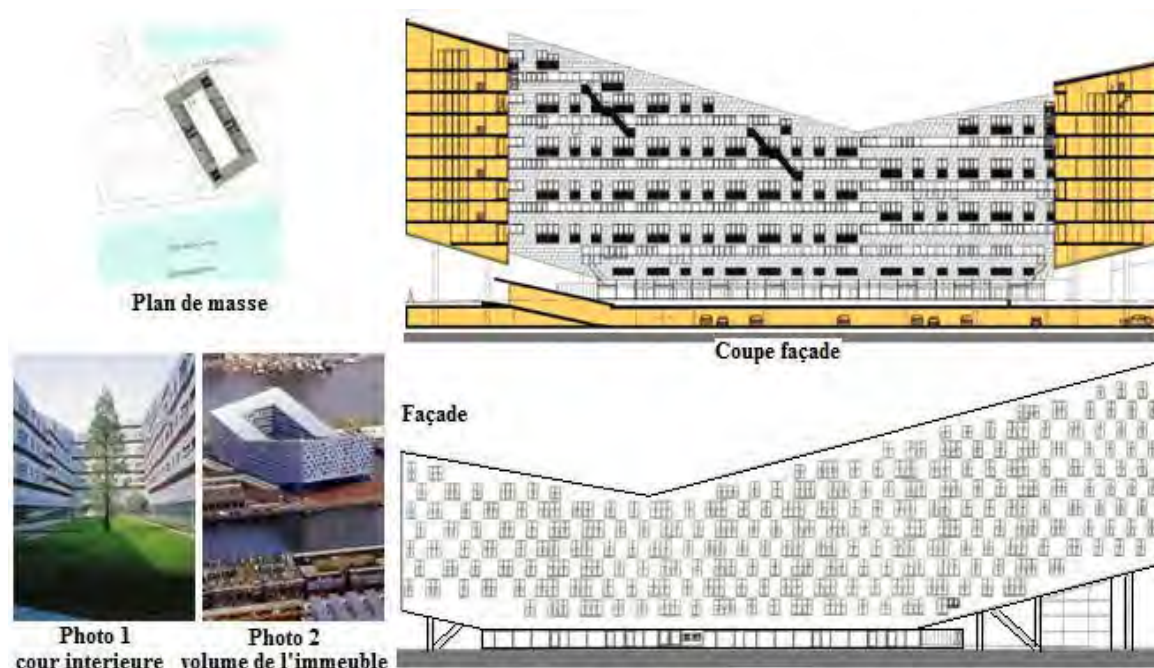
Plan de masse, coupe-façade, façade et photos du complexe résidentiel d'Amsterdam.
